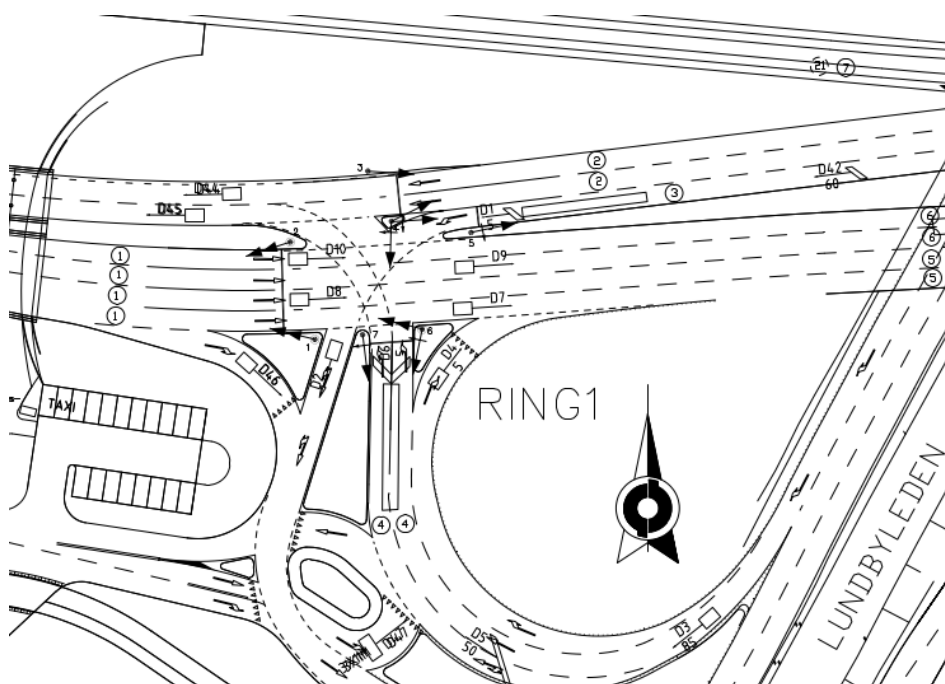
Apparatrum för styrutrustning, mellan Lundbyleden och Hjalmar Brantingsplatsen.
